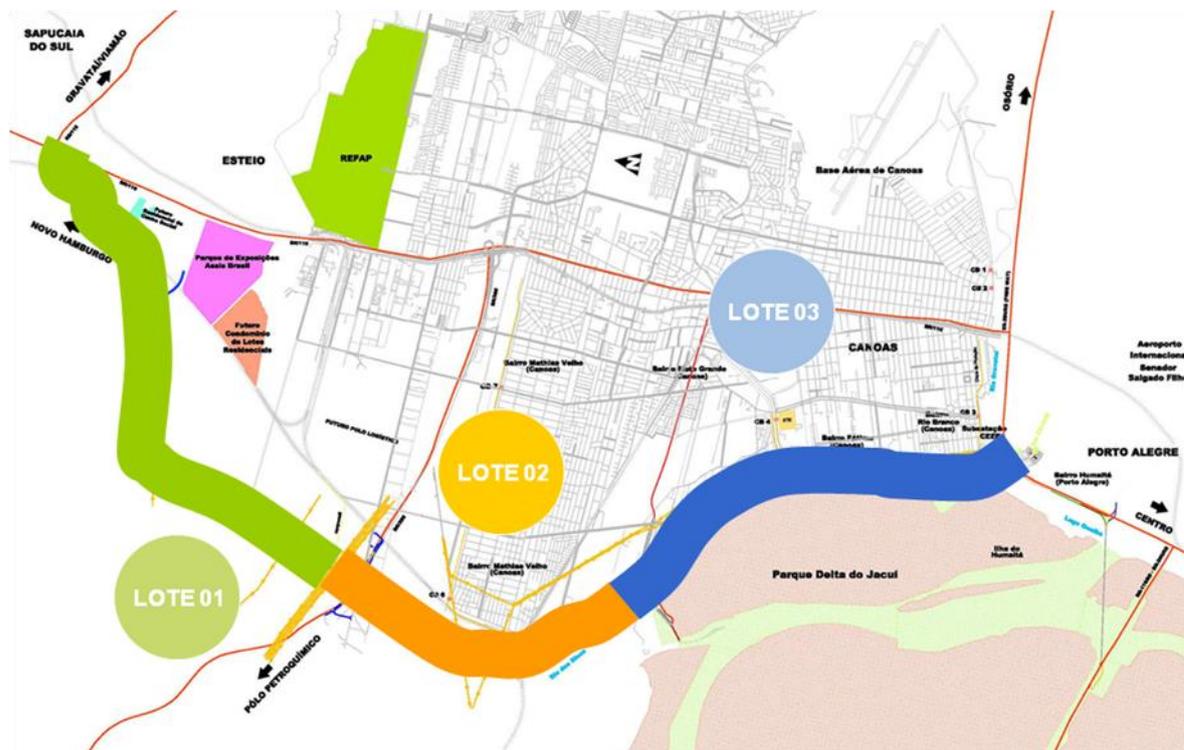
divisão por lotes de construção (trabalho não publicado)²
